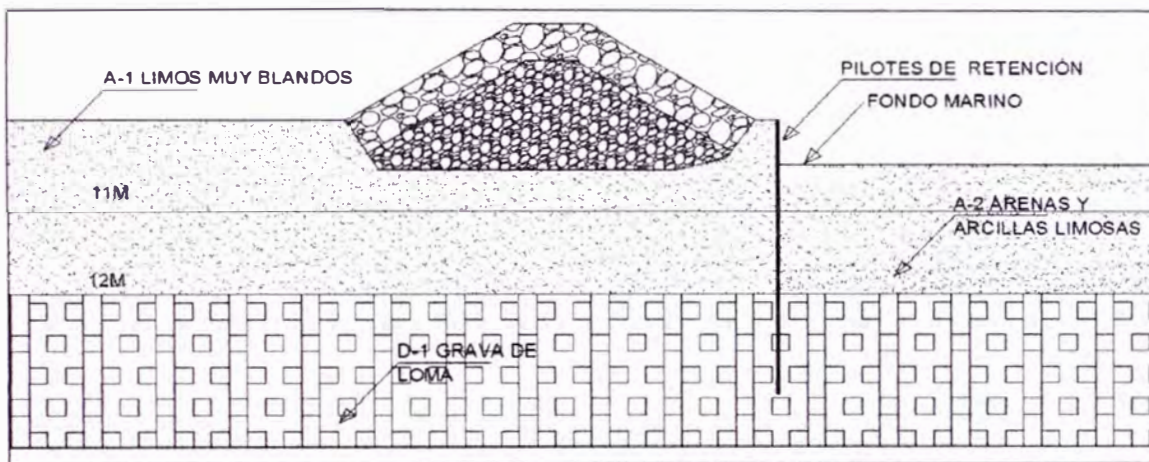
Esquema de pilotes y dragado en el rompeolas norte
